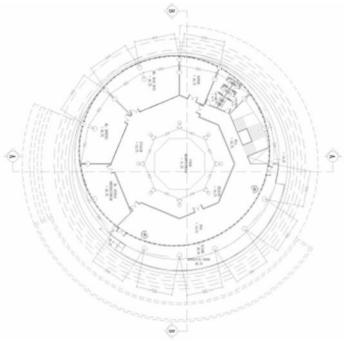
Denah Lantai 1 Gedung Utama (Observatorium) Sumber: Hasil Desain, 2015
